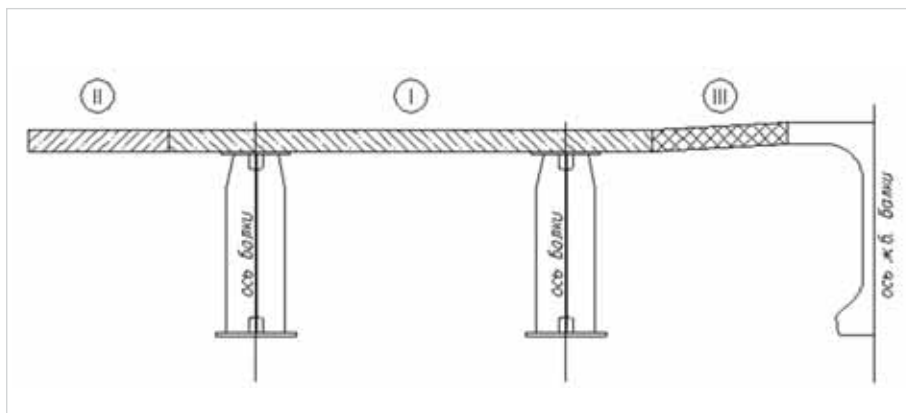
Поперечное сечение (фрагмент) с заменой типовой железобетонной балки на сталежелезобетонную
